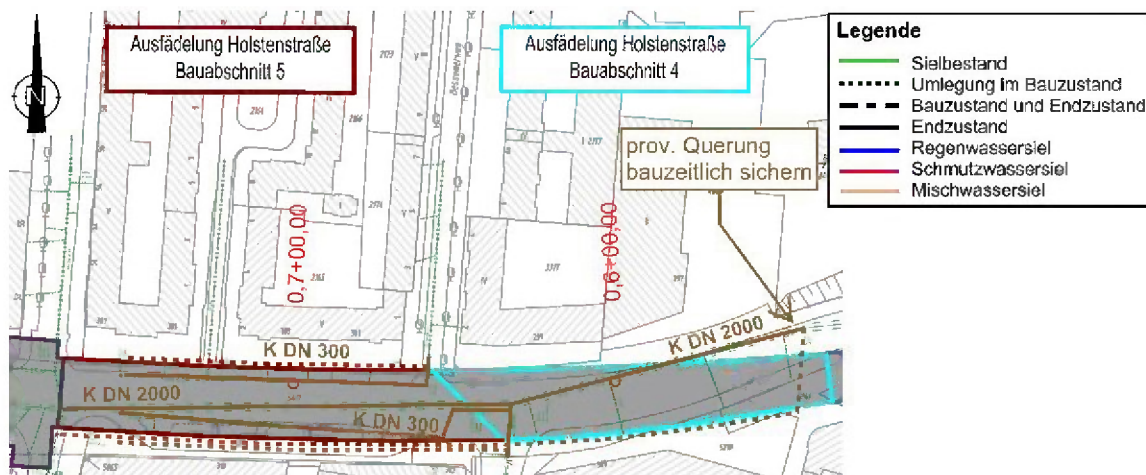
Sielplan Baubereich Ausfädelung Holstenstraße, Bauabschnitte 4 und 5 (Stand 04.2019)
